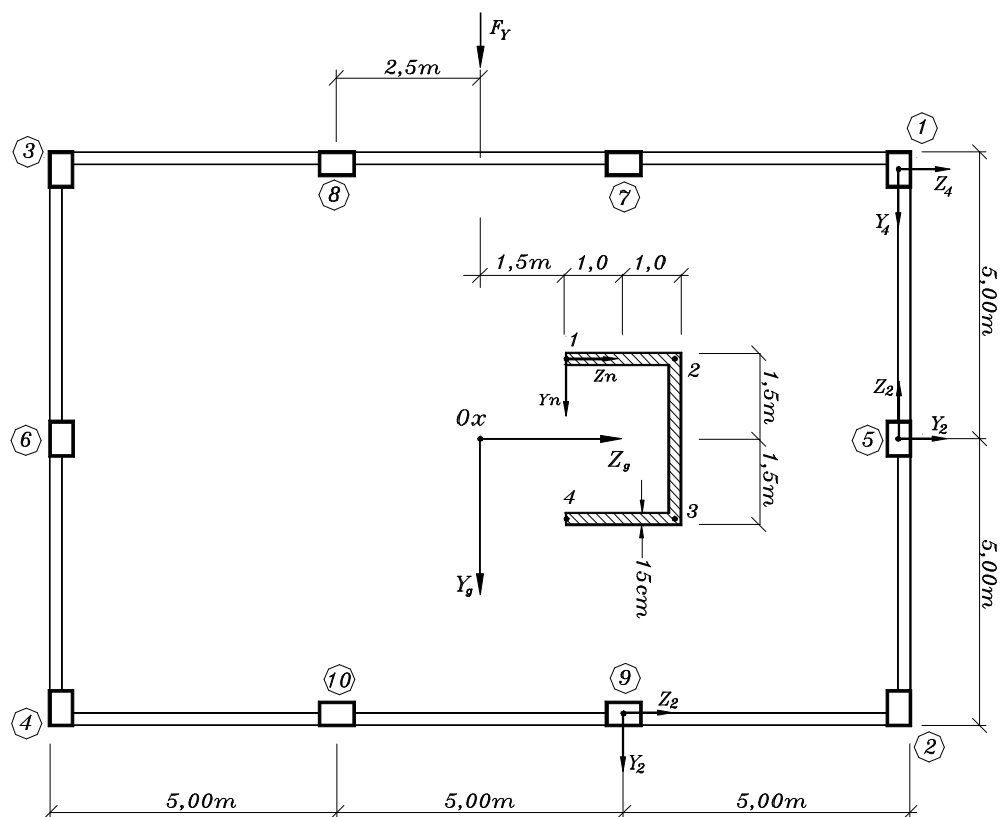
Planta baixa da estrutura do Exemplo SILVA
